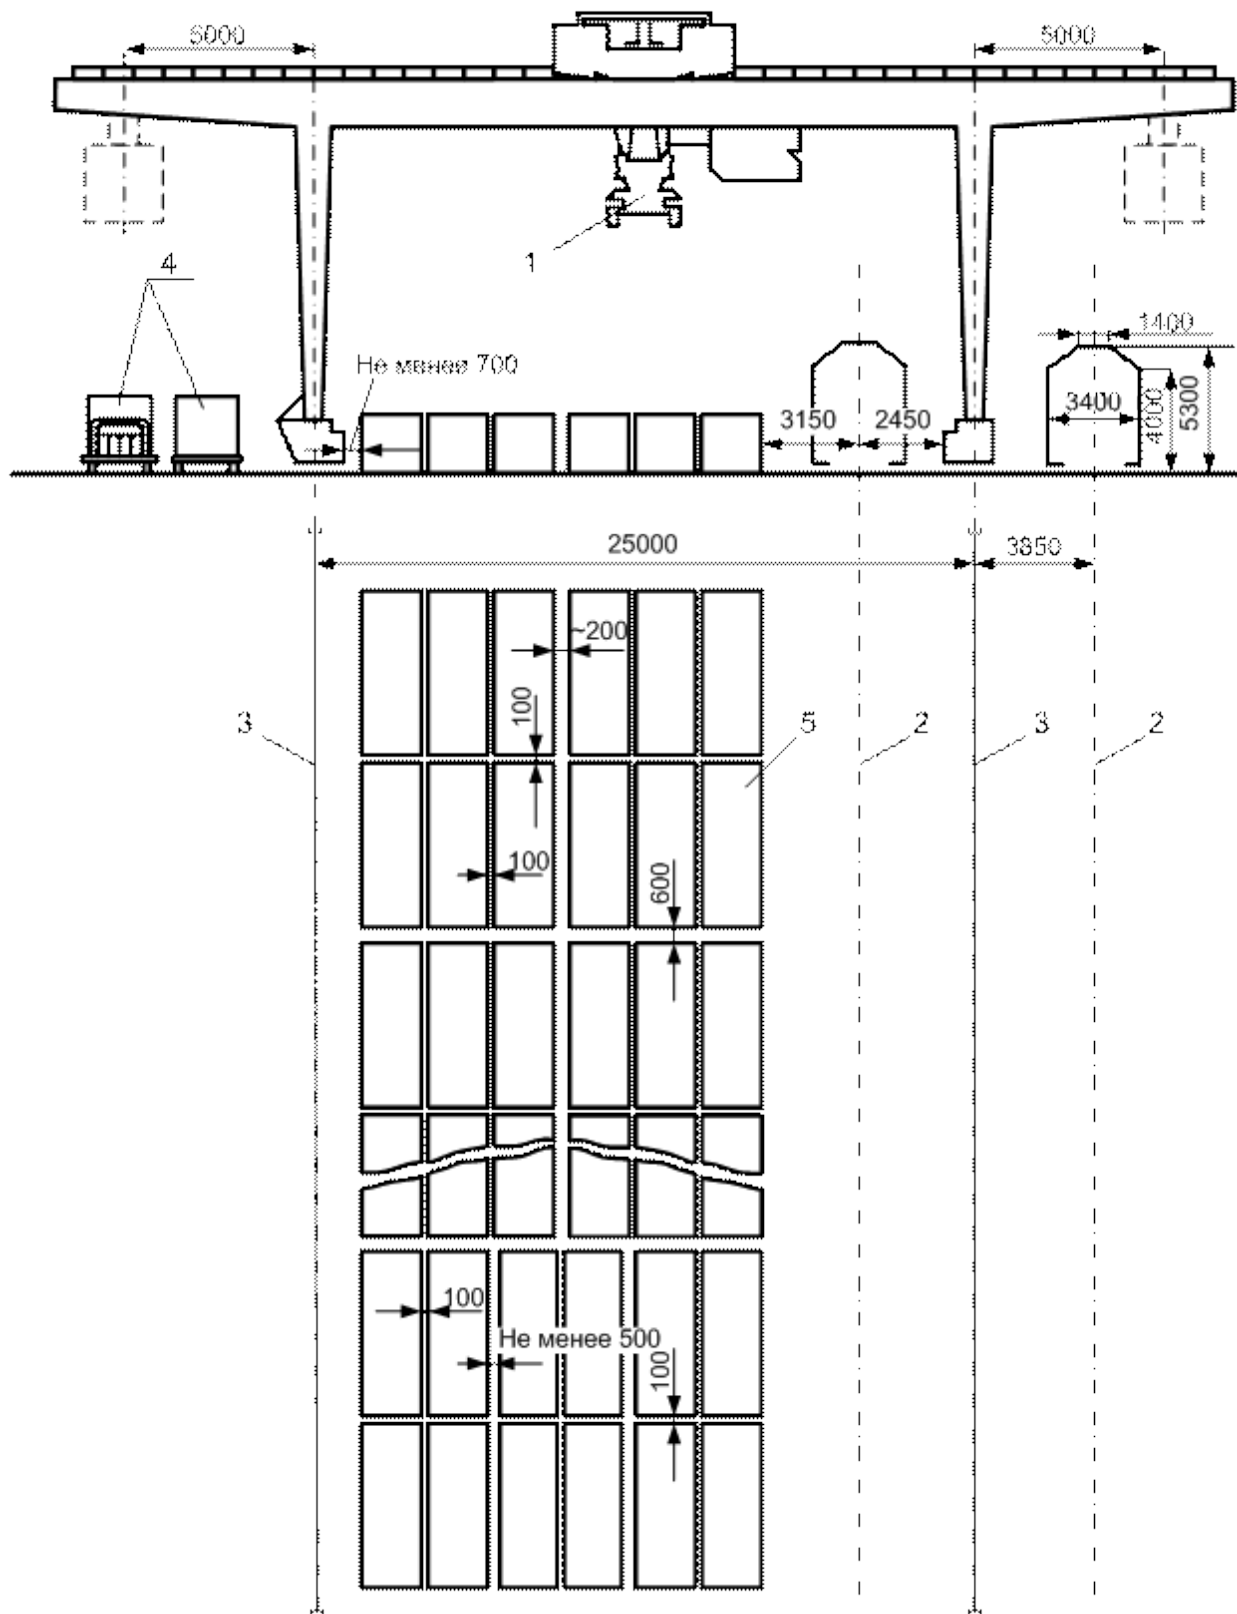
Схема комплексной механизации и размещения крупнотоннажных контейнеров 1С (1СС) на площадке с двумя погрузочно-разгрузочными путями, обслуживаемыми козловым краном пролетом 25 м: 1 – грузовая тележка крана; 2 – оси железнодорожных путей; 3 – подкрановые пути; 4 – автомобили для заезда-выезда контейнеров; 5 – контейнеры массой брутто 20 (24) т
